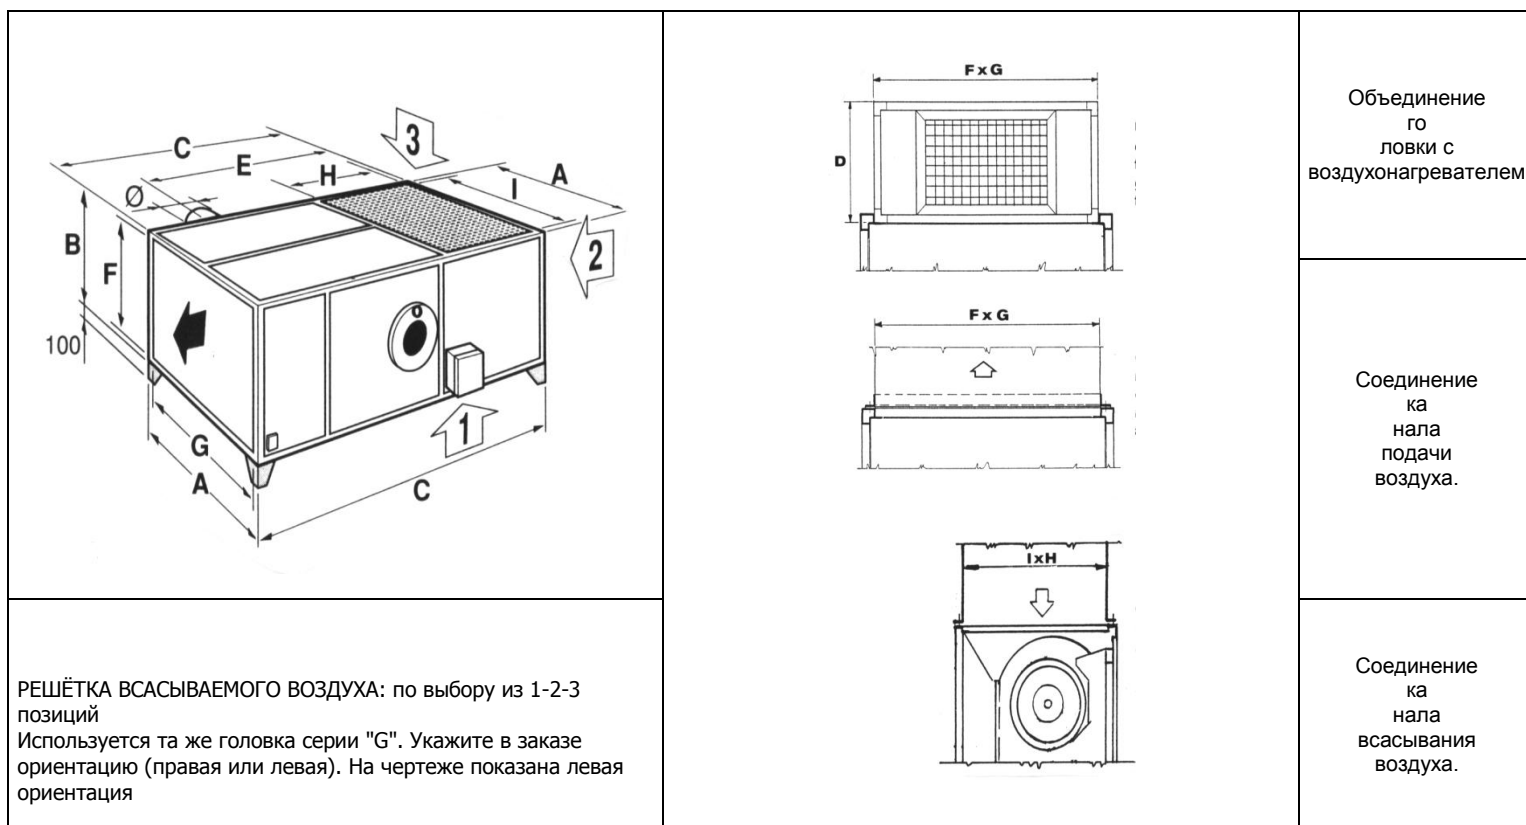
Воздухонагреватель серии G (сверху) и воздухонагреватель серии GE (внизу)
